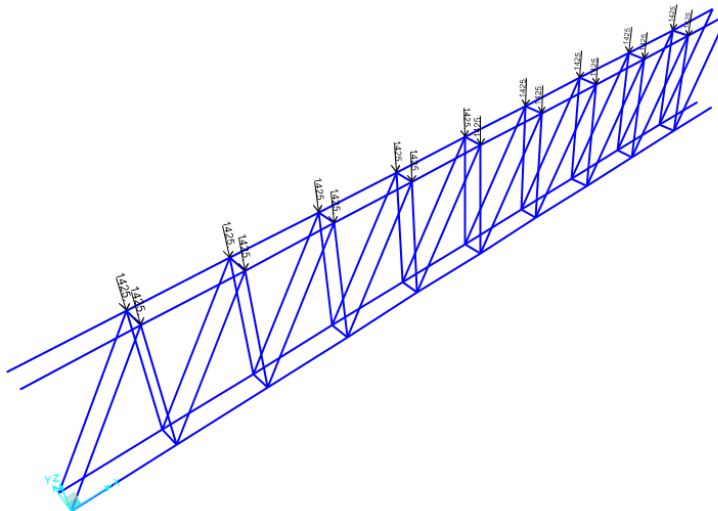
Imagen Isométrica de la propuesta de la trabe armadura.
